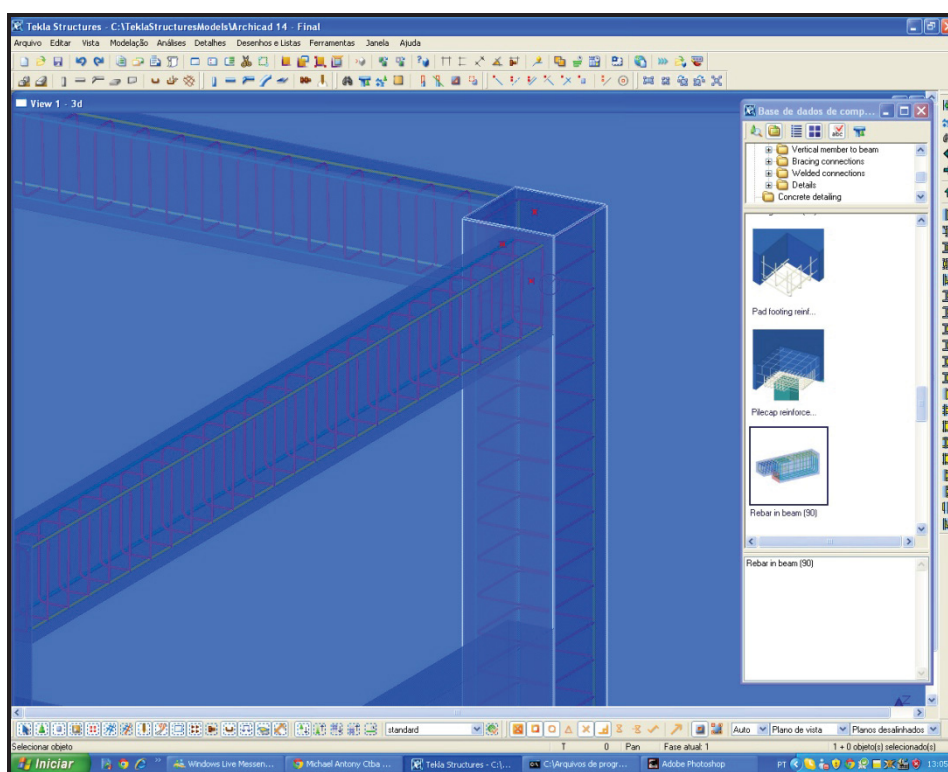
ARMADURAS INSERIDAS NOS MODELO – TEKLA STRUCTURES
